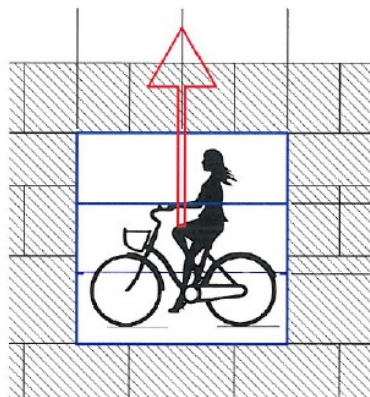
Przykładowy sposób układania betonowych płyt chodnikowych.
